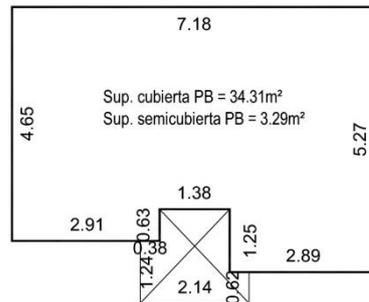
Plano de ubicación de las construcciones Lote B1-i2
